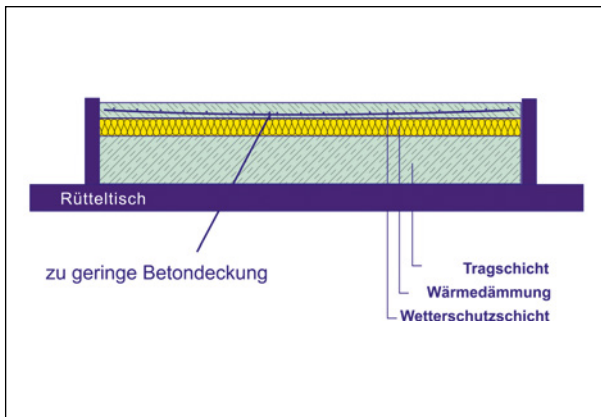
■ Prinzipskizze zur Positiv-Fertigung von Beton-Sandwichelementen
